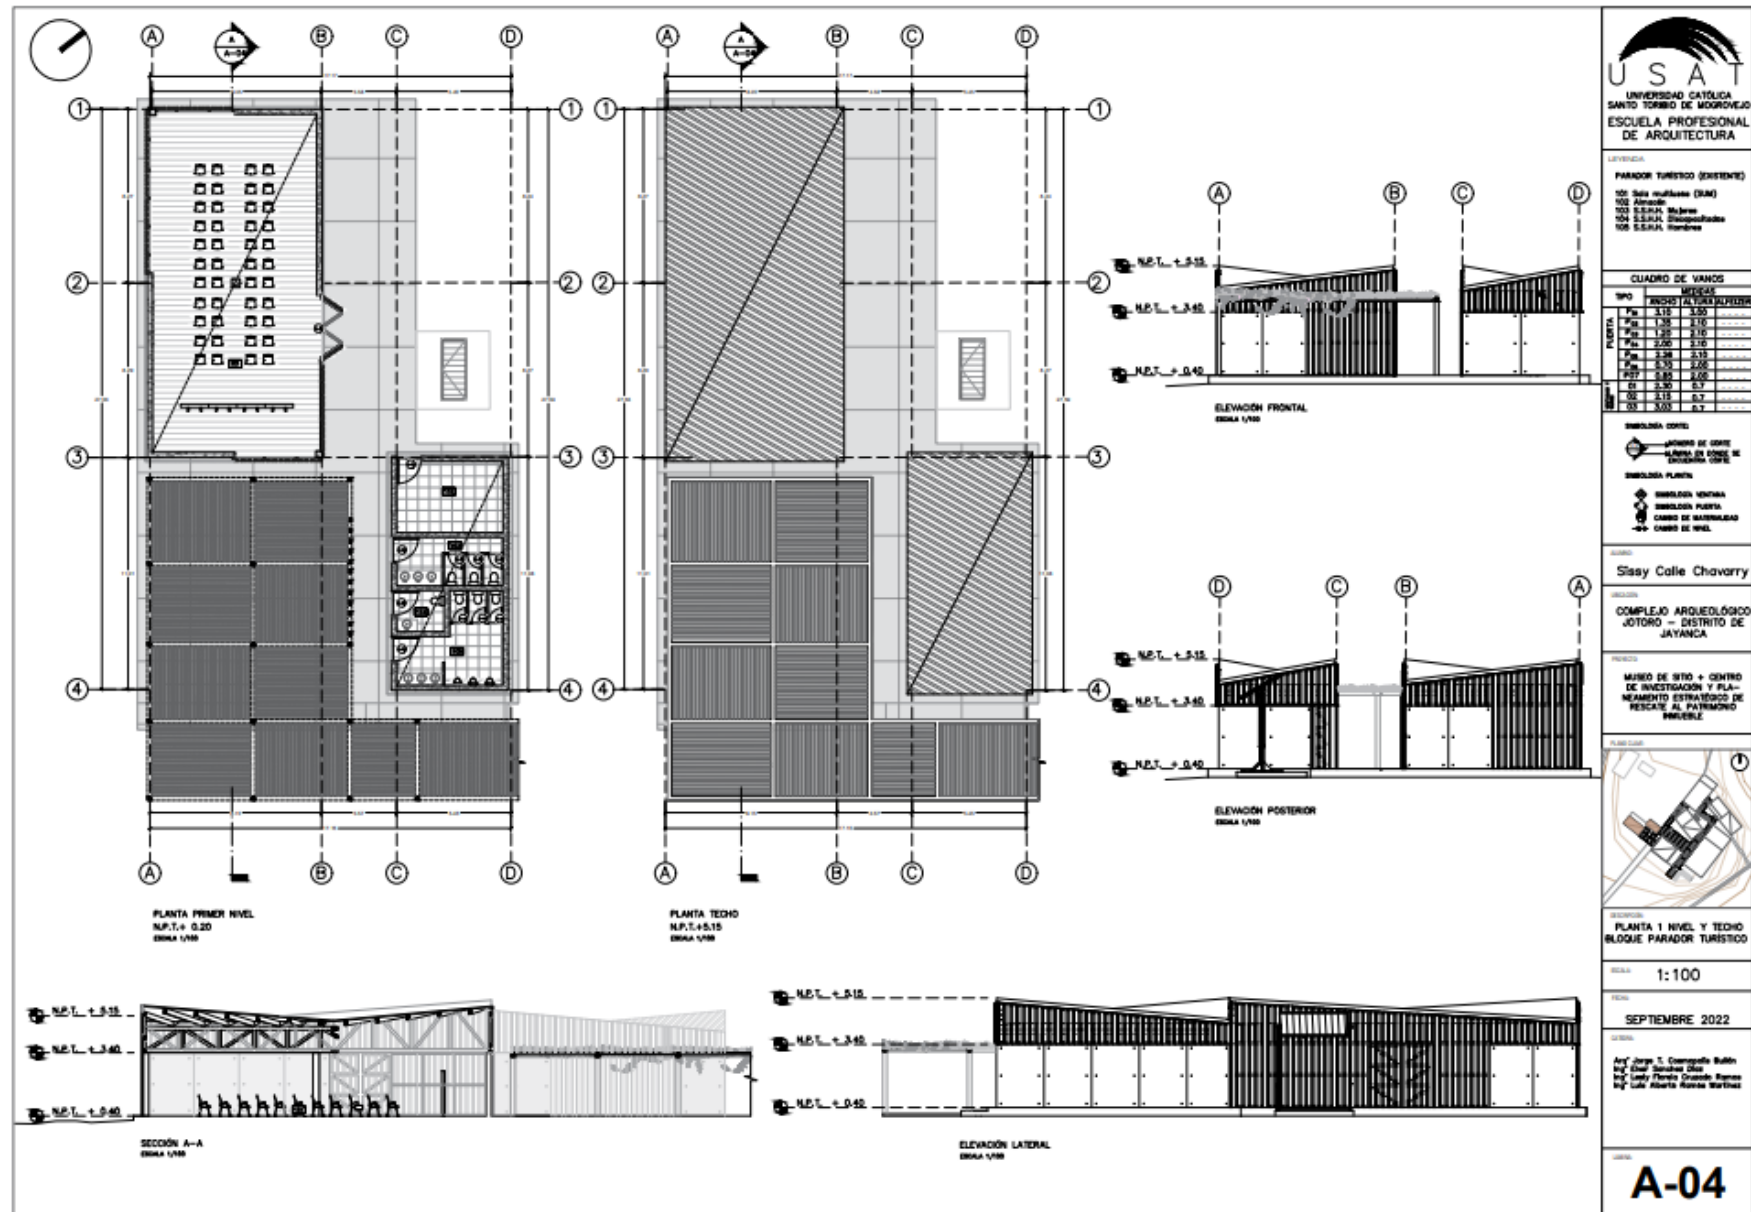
Planos de detalle bloque parador turístico. Fuente: Propia
